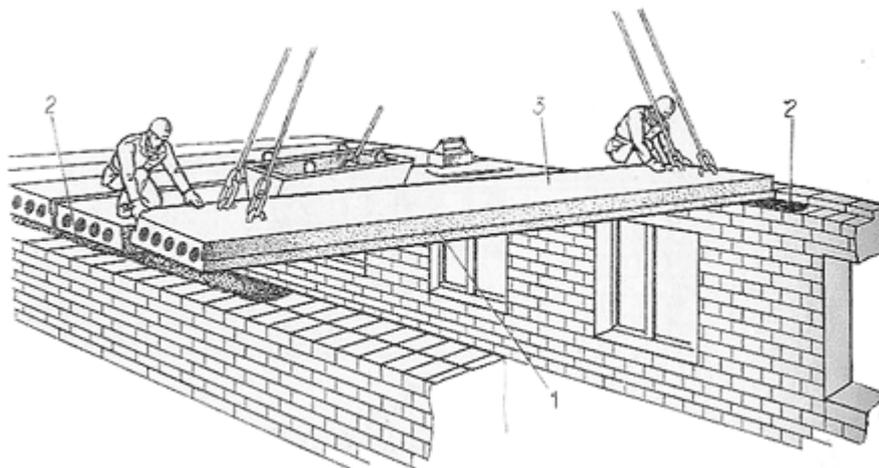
Монтаж панелей (плит) перекрытия:
